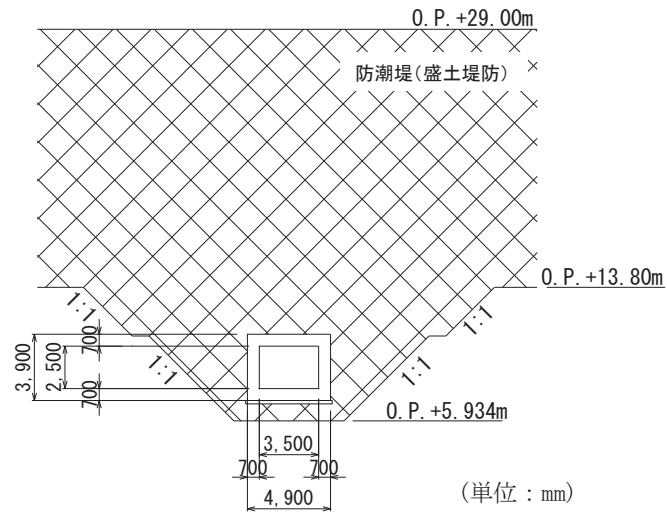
(1) 北側排水路の断面図 (A-A 断面)
